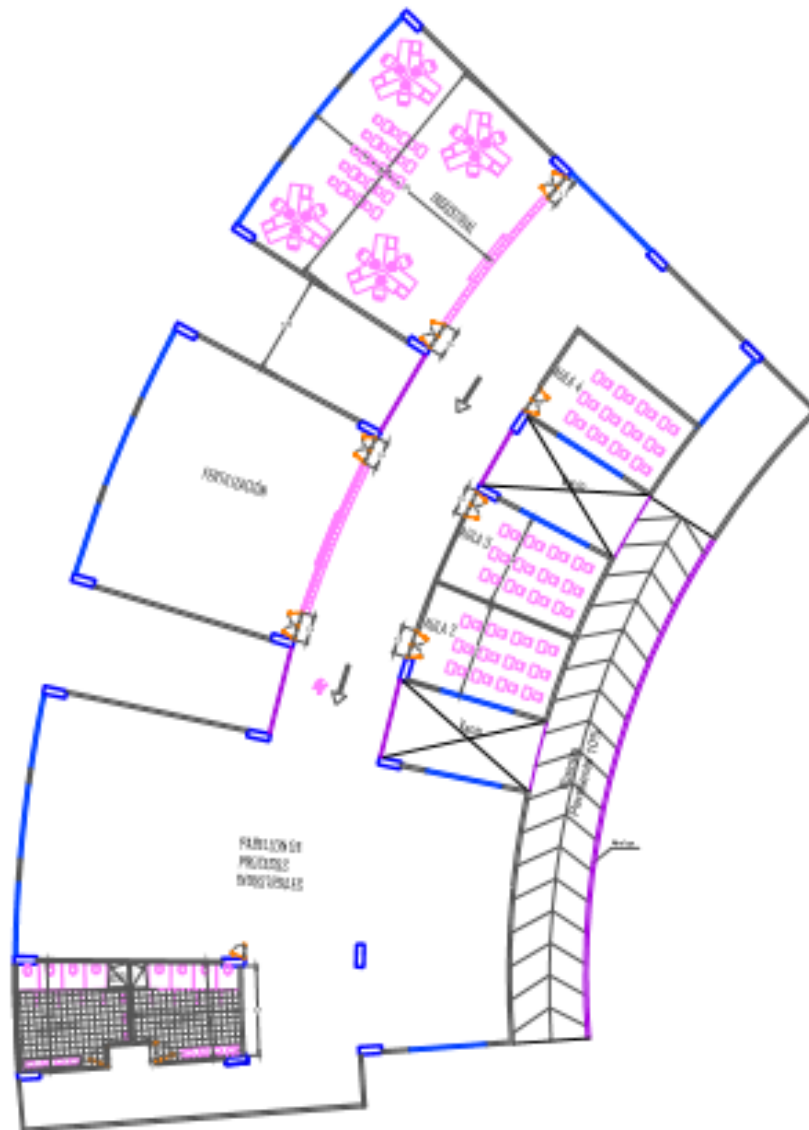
Planta arquitectónica, tercer piso. (Guerrero, 2020).
